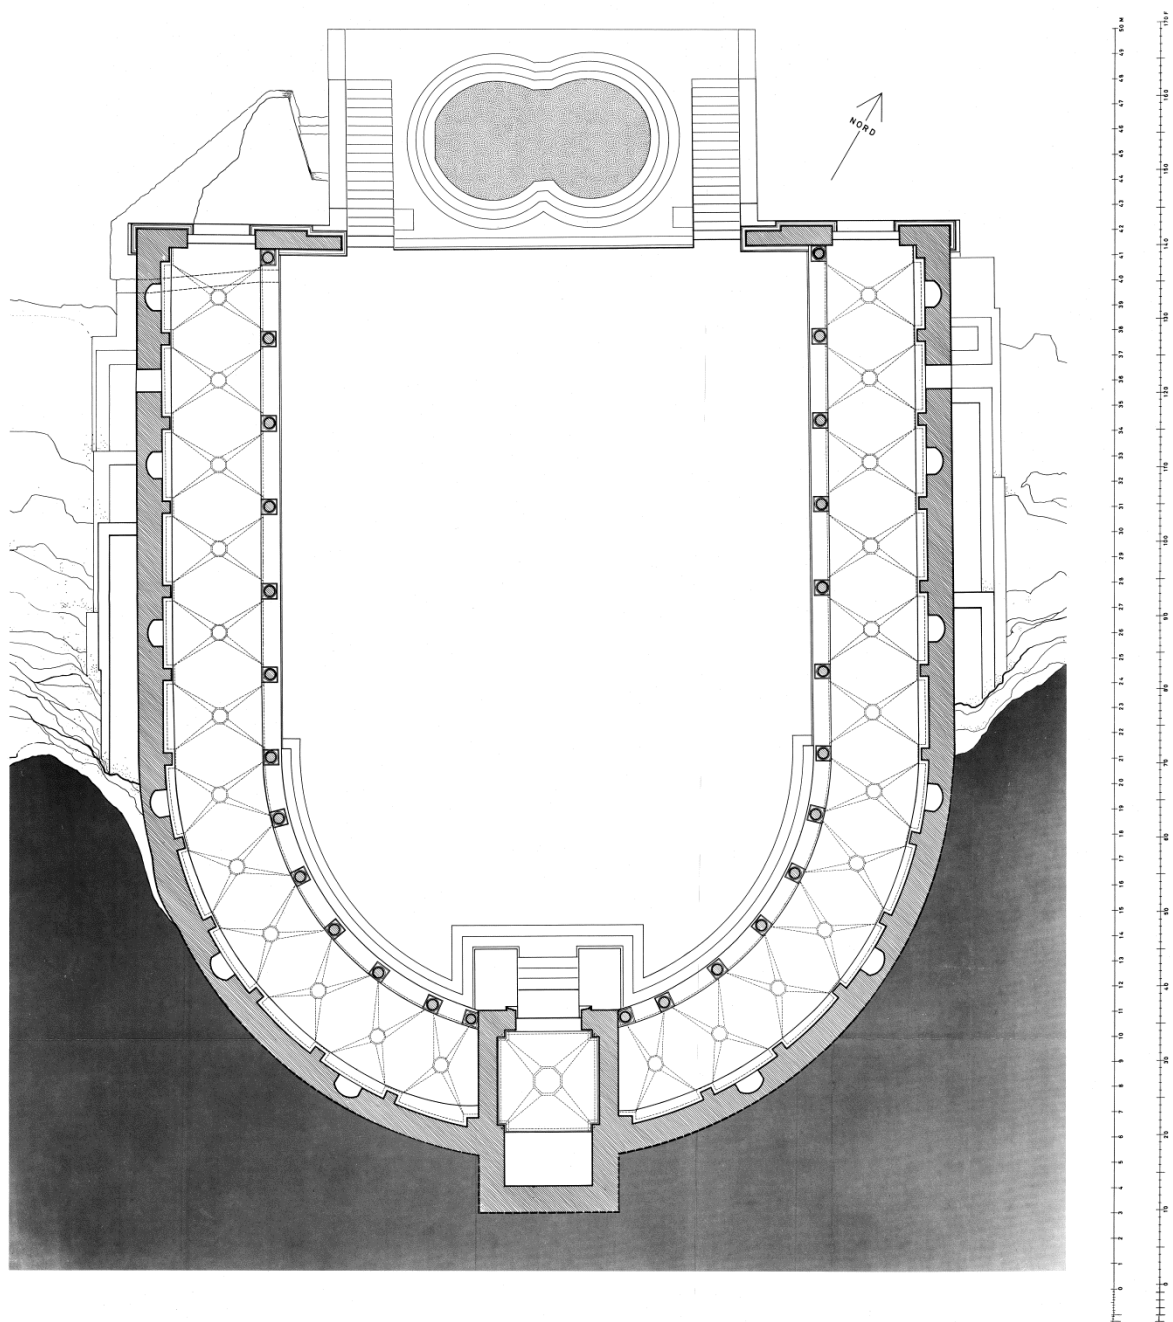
Quellheiligtum Zaghouan – Grundriss Rekonstruktion
